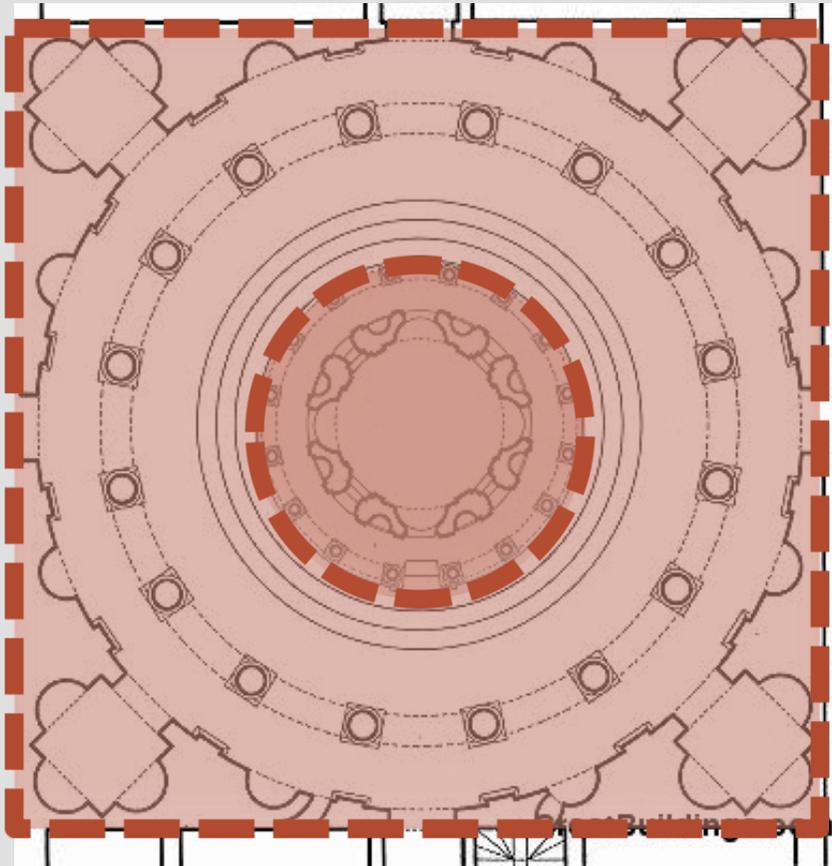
Planta baixa do conjunto Tempio di San Pietro
